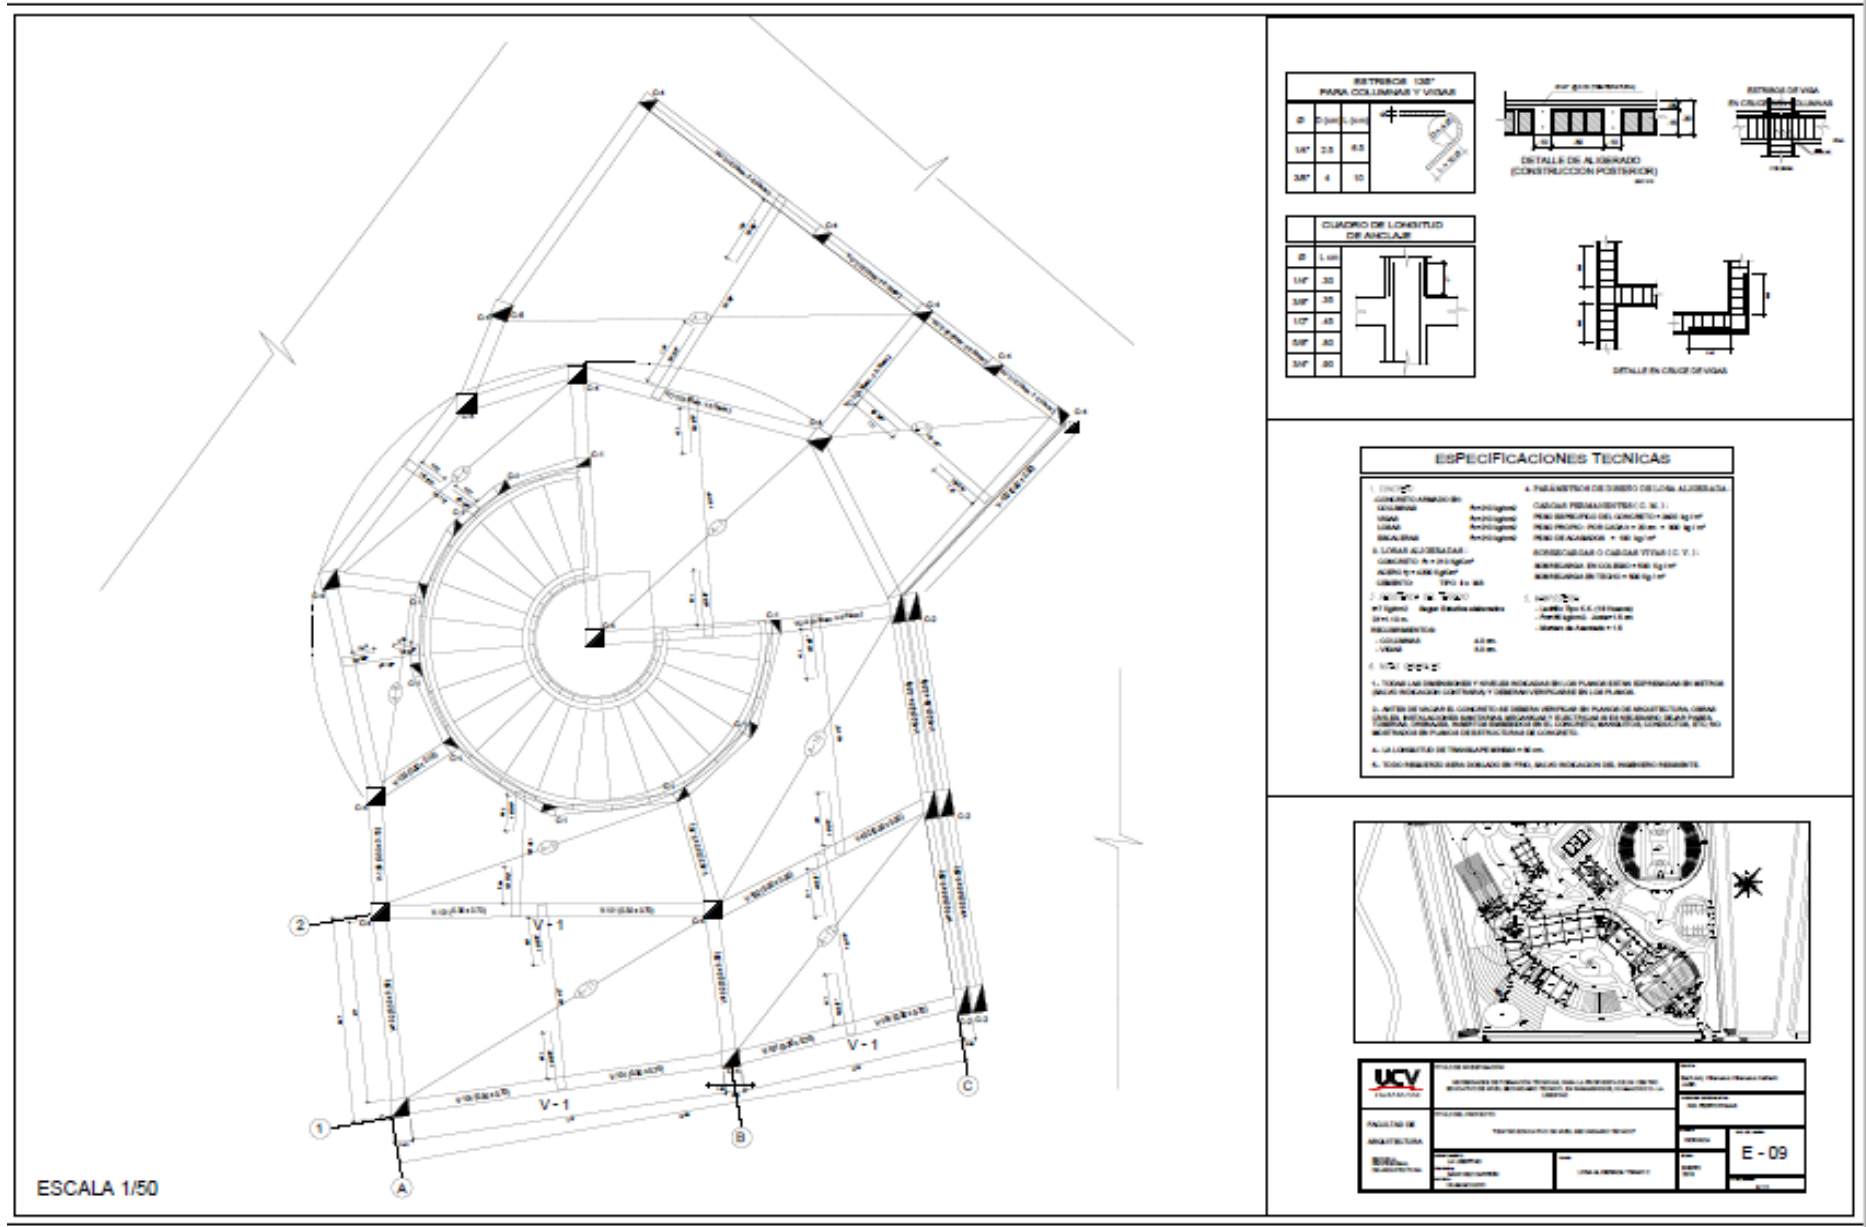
Plano Diseño Estructural Bloque 02 – Losa Aligerada - Plano N° 17 - Lamina E-09
